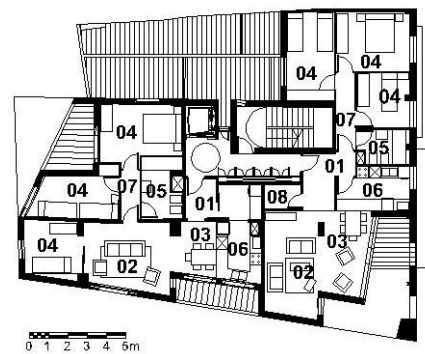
Pavimentos 1º e 2º da Habitação de Proteção Oficial Giralt el Pellisser
